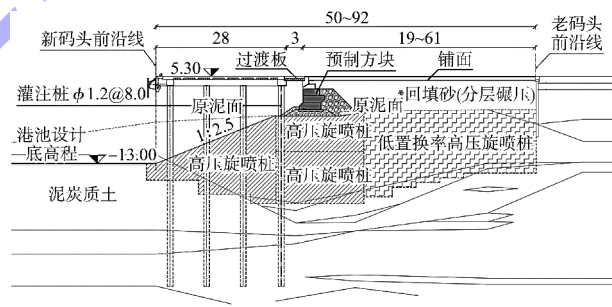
板下岸坡加固式高桩码头方案平面布置和结构断面 (单位: m)
